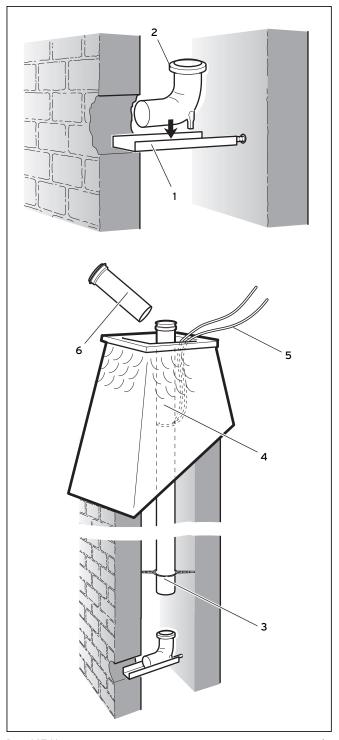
Монтаж опорной планки и опорного отвода, установка труб дымохода в шахту
